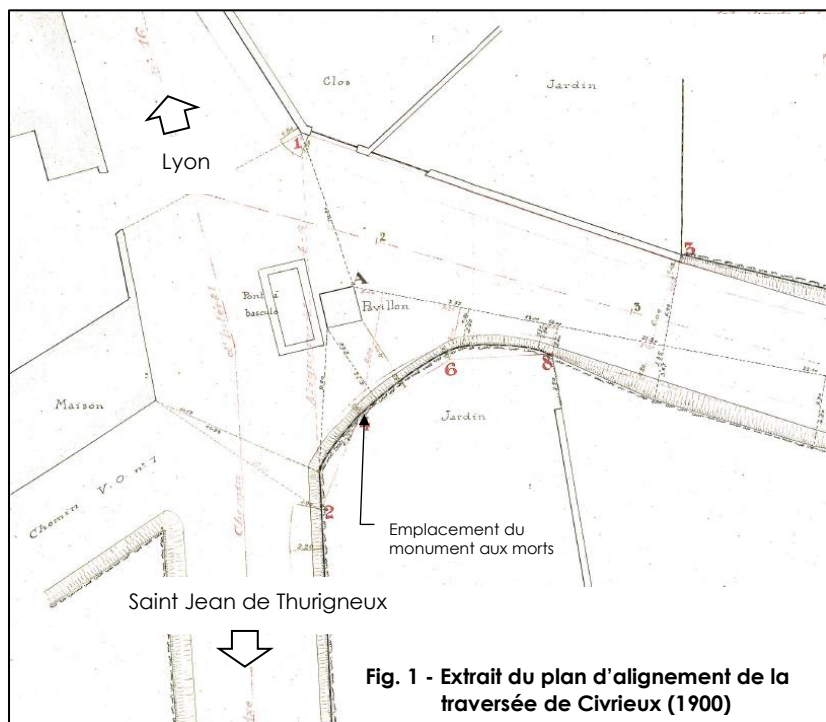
Extrait du plan d'alignement de la traversée de Civrieux (1900)
